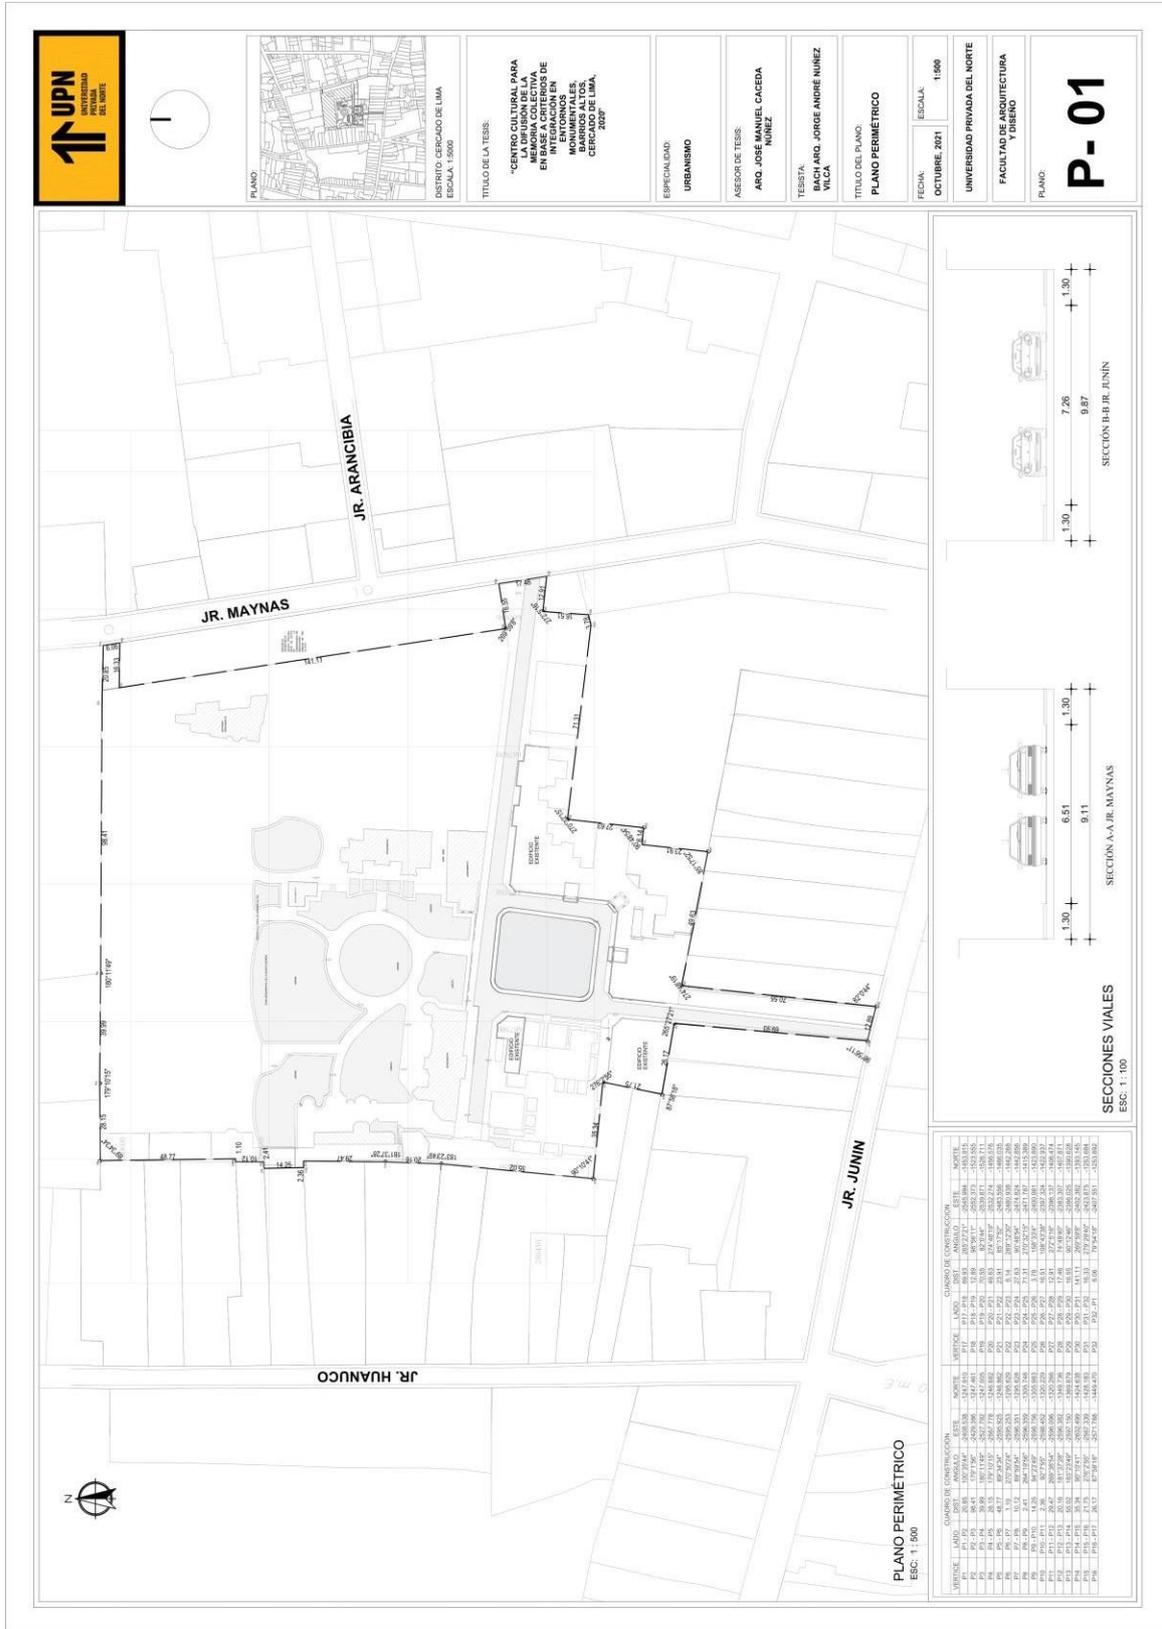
10 Plano localización y ubicación de terreno seccionado.
